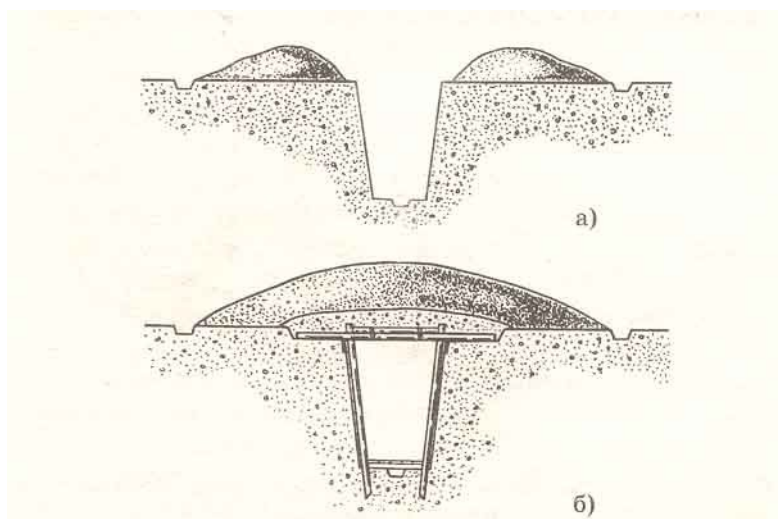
Простейшее укрытие щель: а) открытая; б) перекрытая
